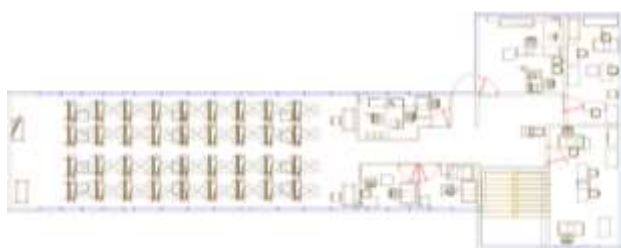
Plano de la planta arquitectónica correspondiente al tercer nivel del edificio académico de “tres niveles”
